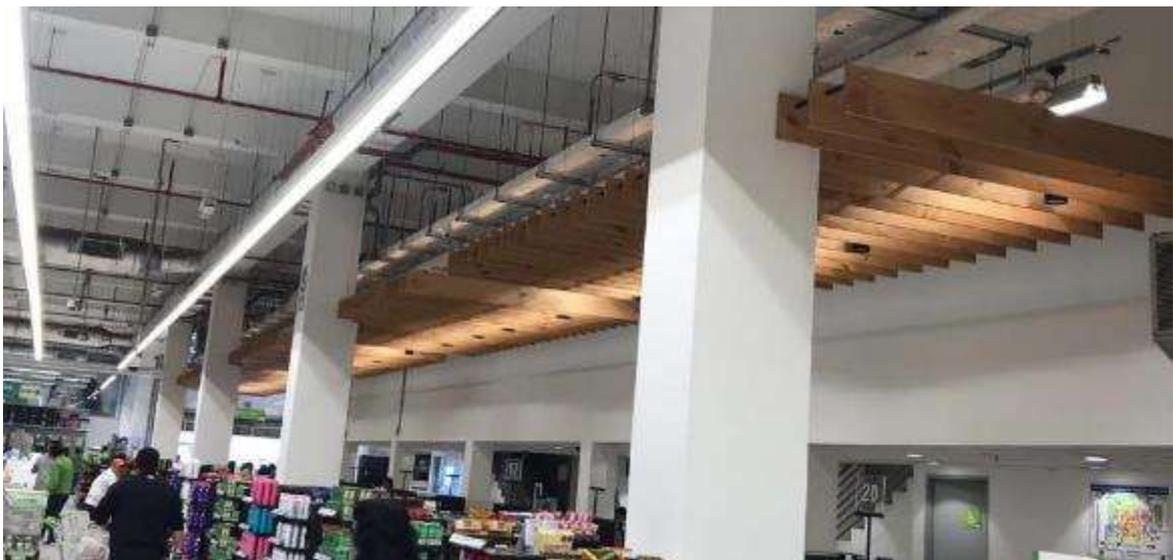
FOTO OBRA - Instalación gráfica en equipamiento existente
